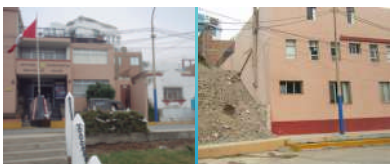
Construcciones como de la Capitanía de Huacho, ubicada en Av. Luna Arrieta, presentan fisuras y grietas en muros y en la parte posterior por lo que es necesario realizar las medidas correctivas para evitar su continuo deterioro.
